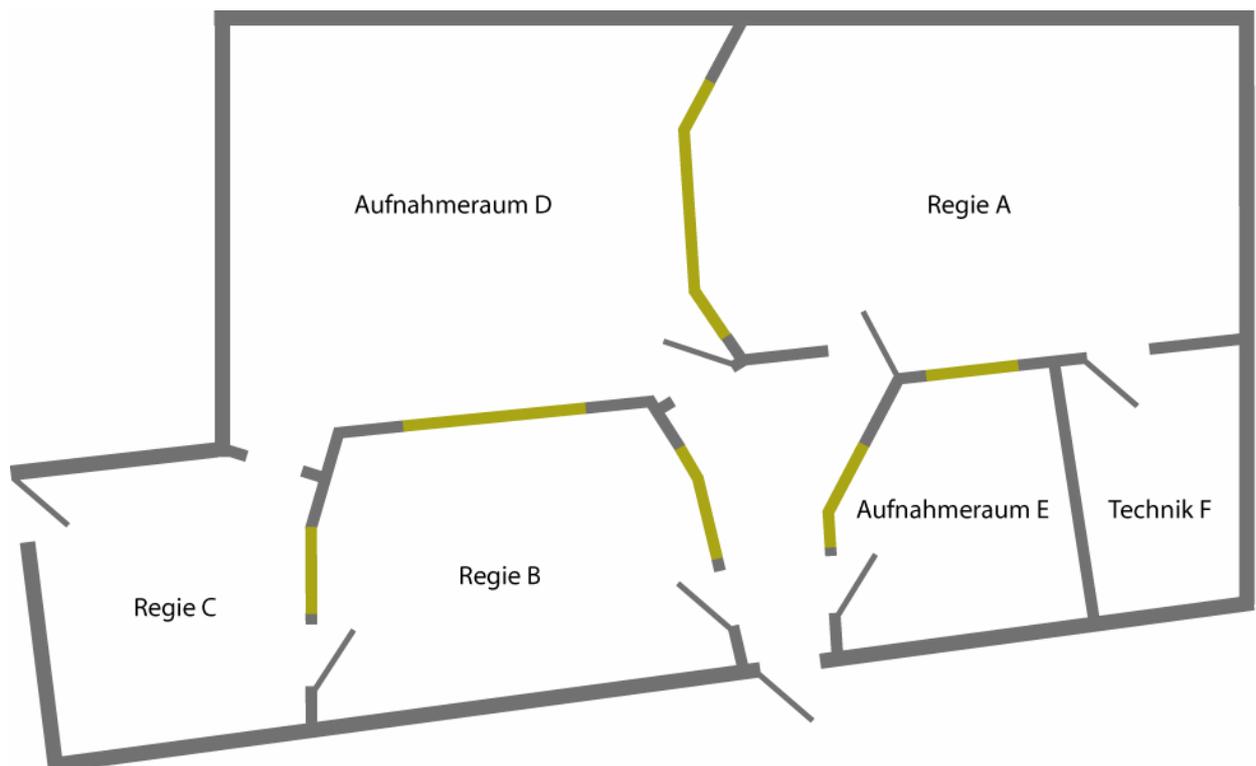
Grundriss des Tonstudioskomplexes
